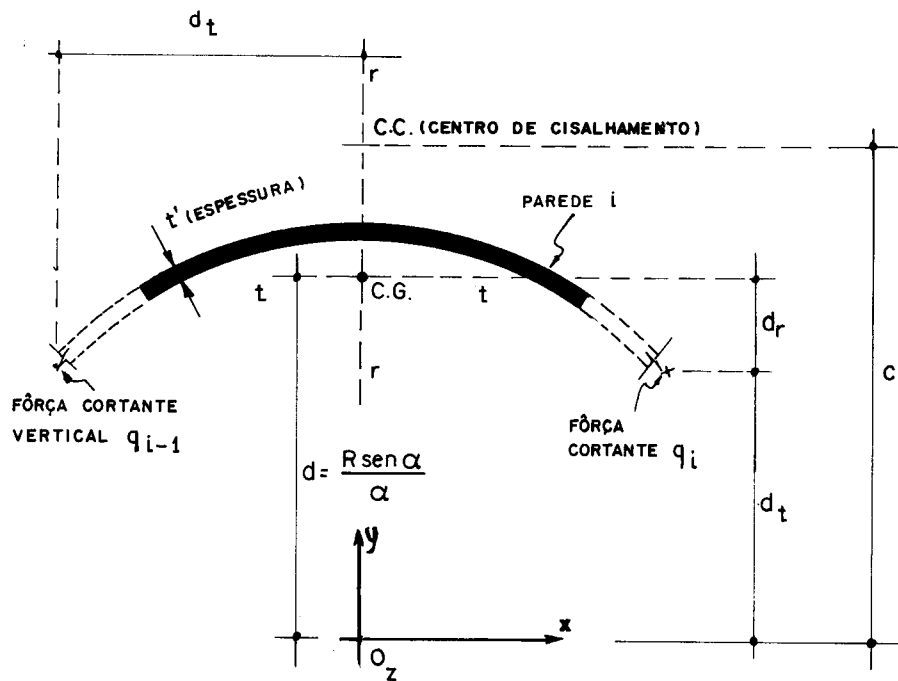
PAREDE i ISOLADA, EM PLANTA
